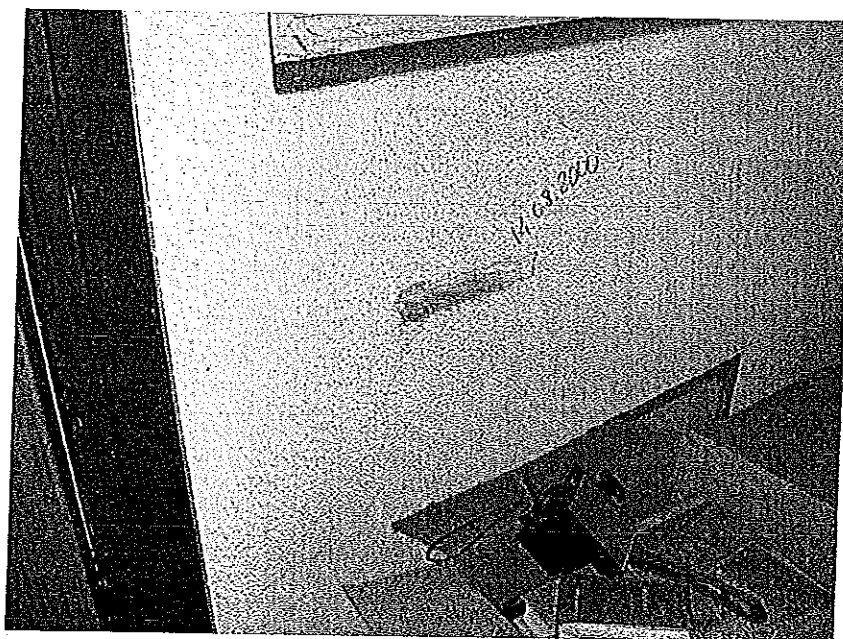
Crepa evidenziatasi sulle murature dell'appartamento – locale E.
